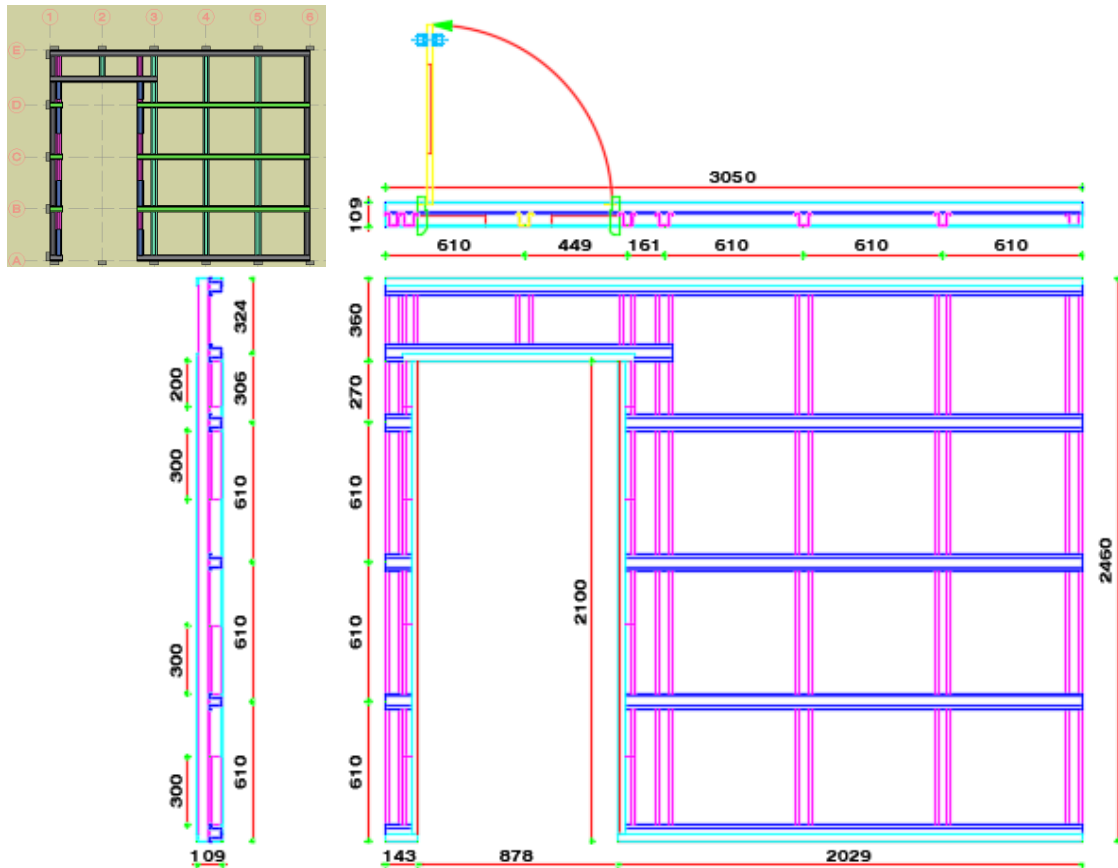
Dimensiones de panel puerta de 3.050mm x 2.460mm
